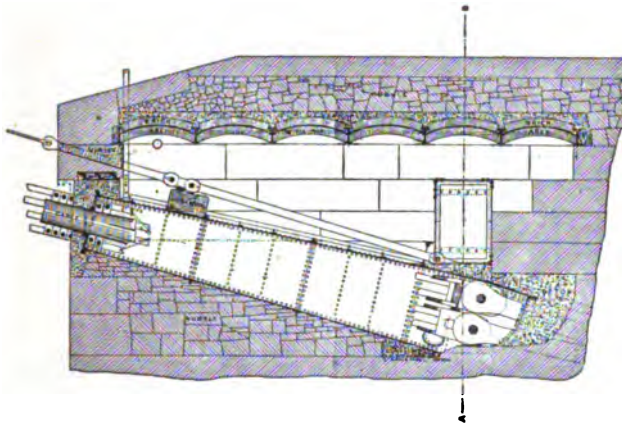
Coupe longitudinale d'un Ancreage réparé.
